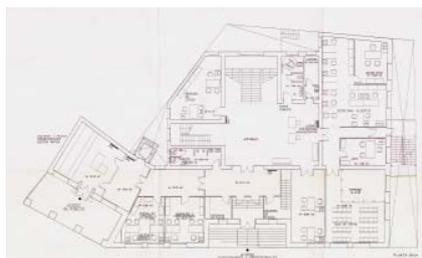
Plano de la planta principal del edificio con las modificaciones de 1999 - Archivo Municipal Huesca
